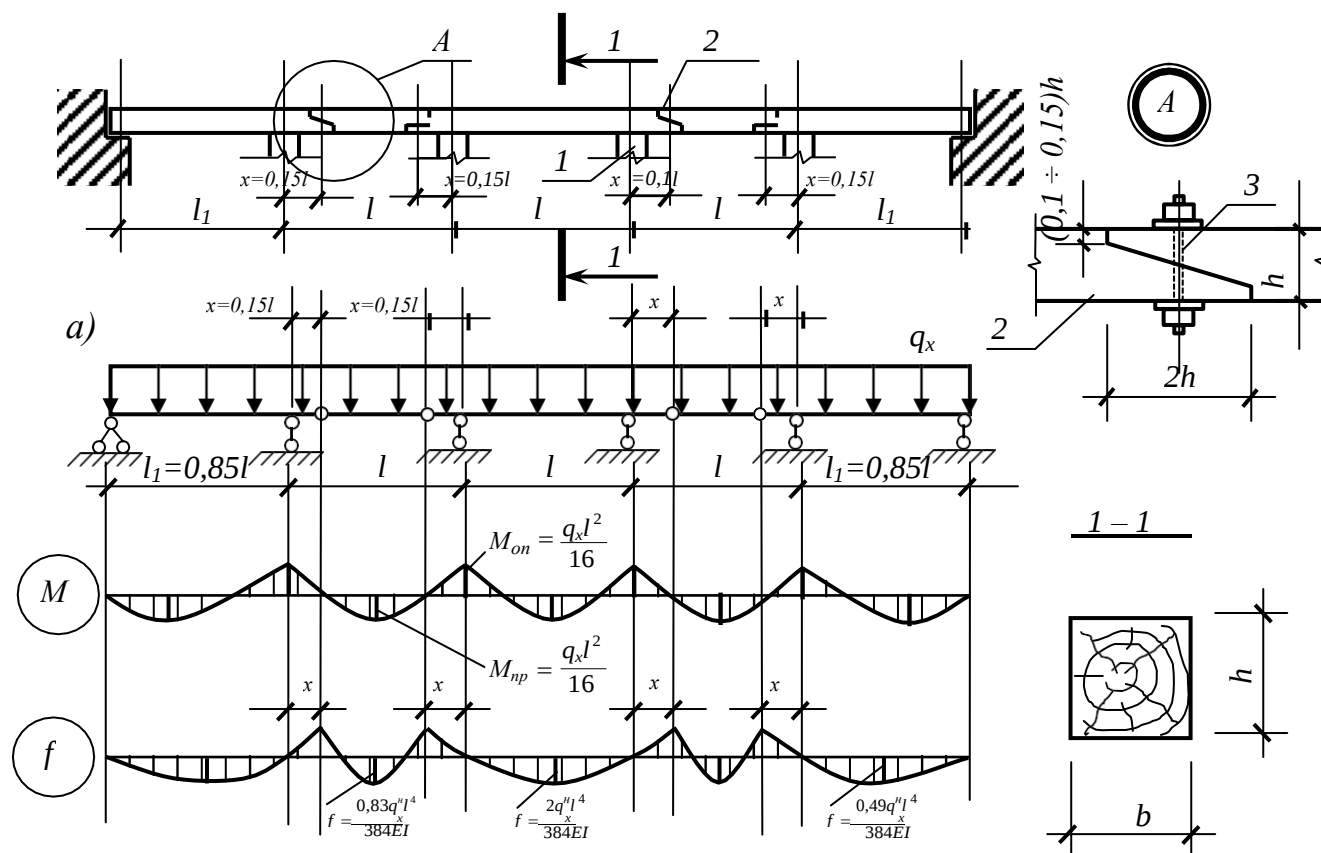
Схема консольно-балочного прогона: а – расчетная схема прогона и эпюры M и f ; 1 – несущая конструкция; 2 – прогоны; 3 – болт
